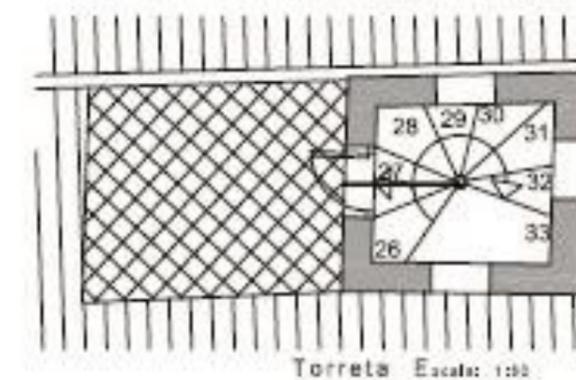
Planta cubiertas 5º desembarco y final de escalera de caracol Fuente: Propia
